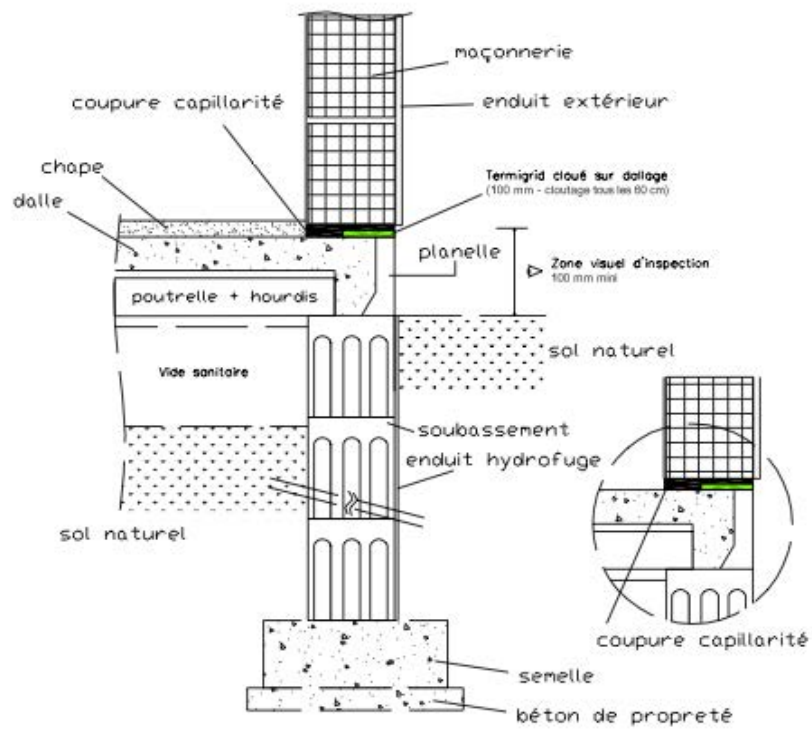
Coupes sur planchers bas constitué d'un plancher sur vide sanitaire.
